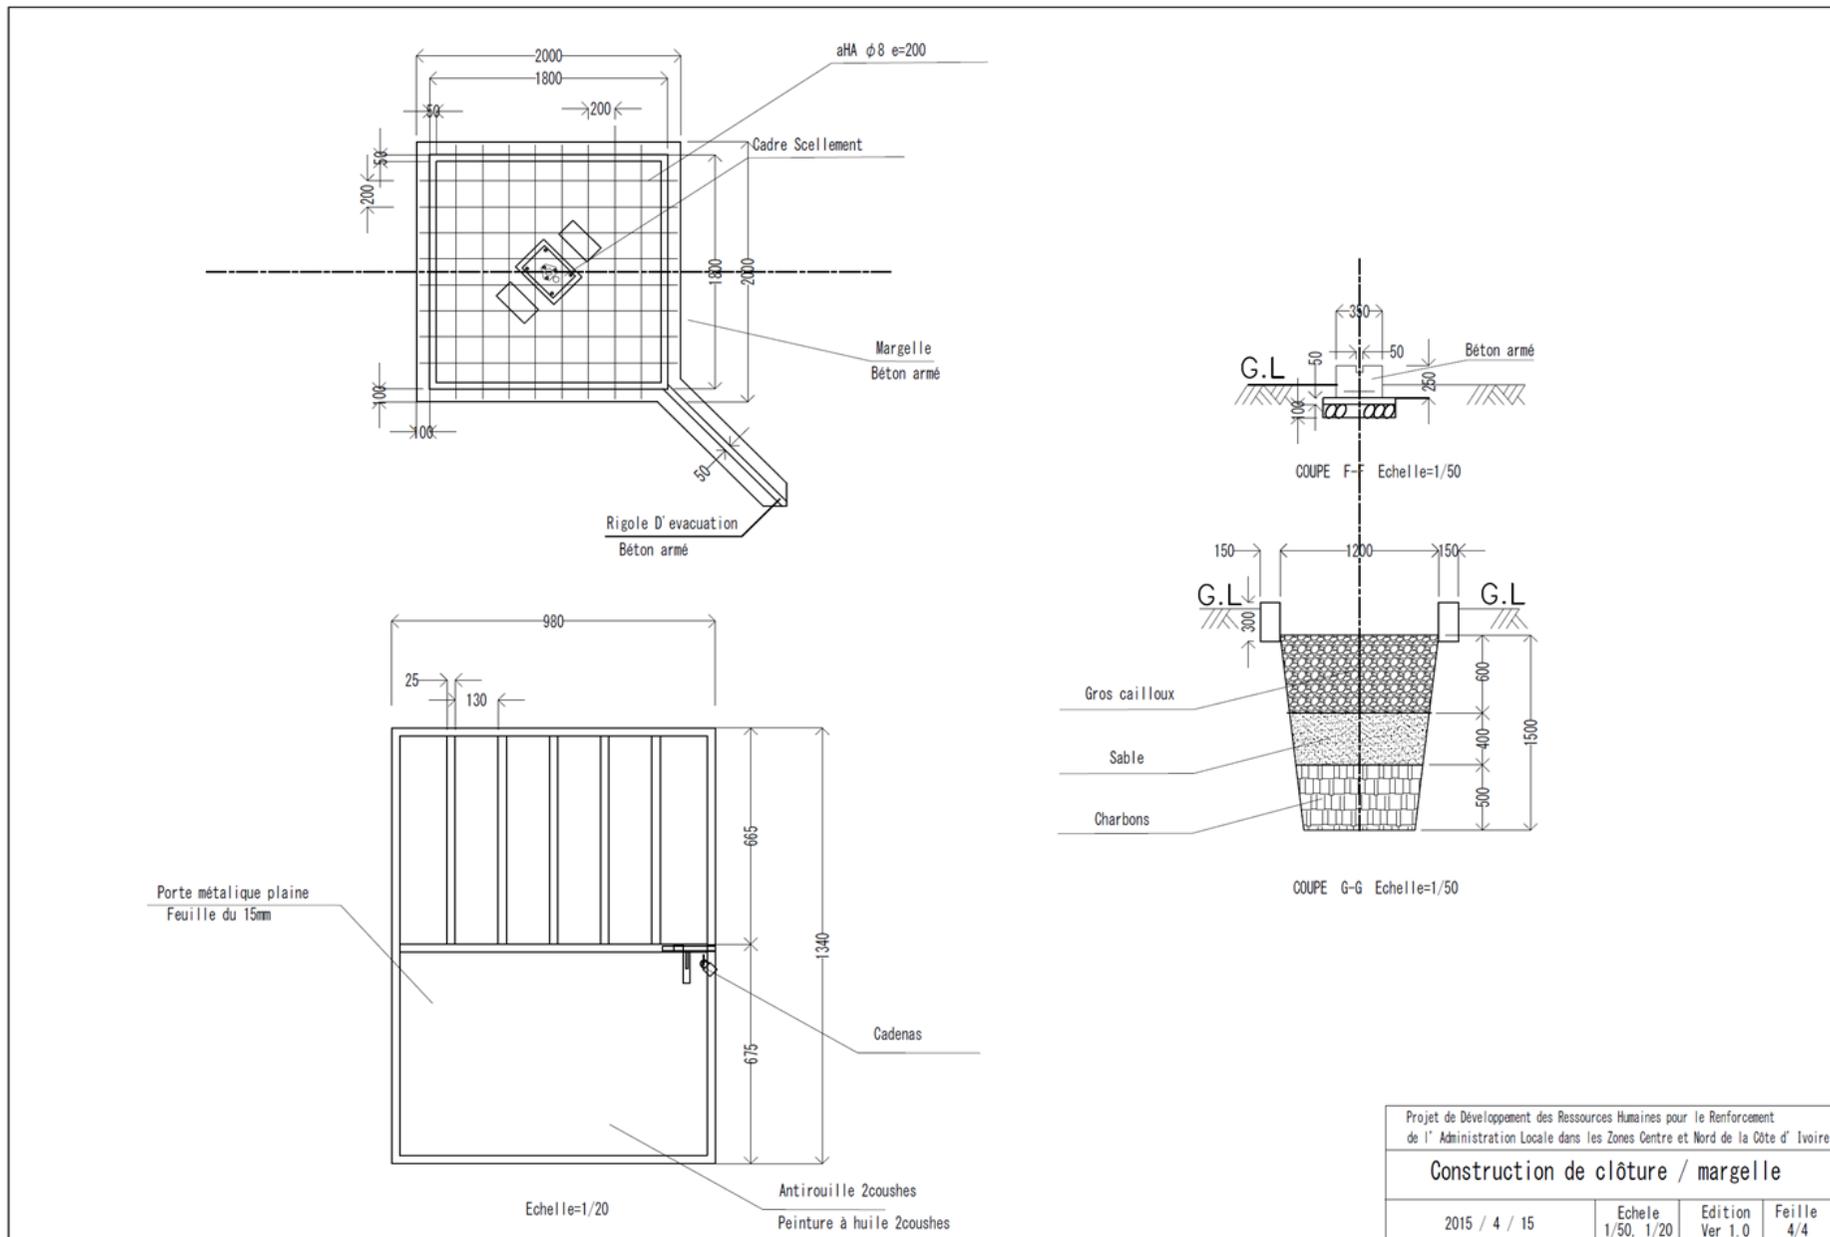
Plan de la superstructure d'une PMH (4/4)
